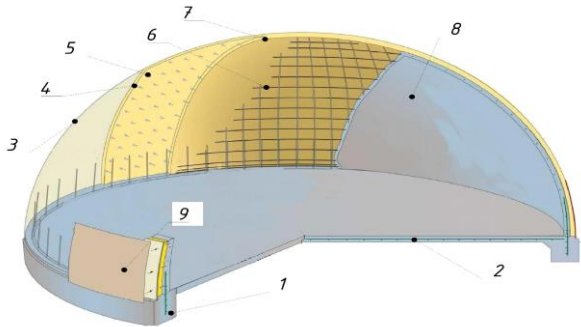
Технологічний процес створення купольної конструкції з використанням пневматичної опалубки: 1 - кільцева балка фундаменту; 2 - бетонна плита; 3 - пневматична опалубка; 4 - перший шар пінополіуретану; 5 - кронштейни для кріплення арматурного каркаса; 6 - арматурний каркас; 7 - другий шар пінополіуретану; 8 - шари торкрет-бетону; 9 - зовнішнє опорядження.
